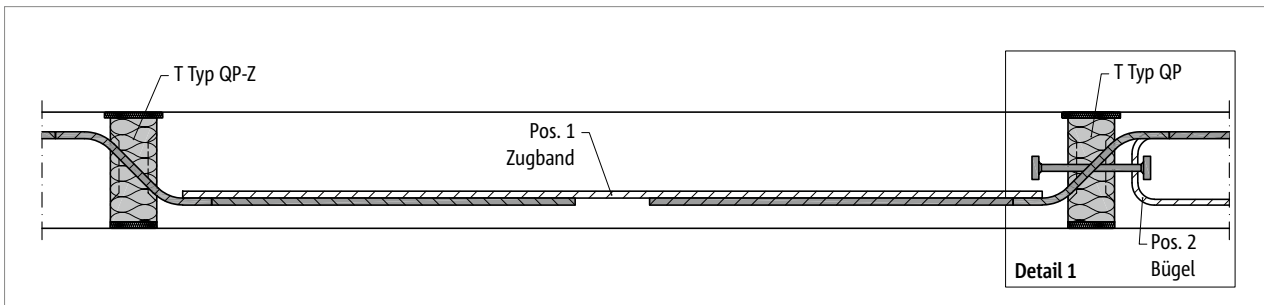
Schöck Isokorb® T Typ QP-Z, QP: Schnitt A-A; Bewehrungsanschluss Zugband
